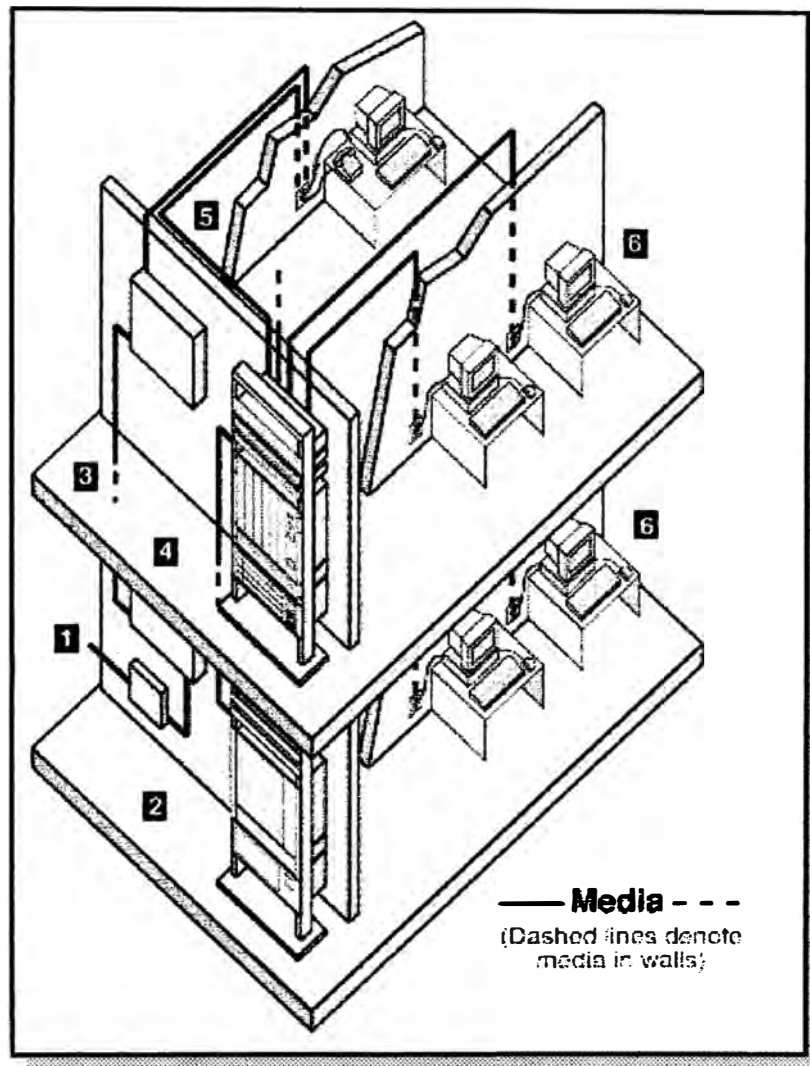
Los 6 subsistemas de un Sistema de Cableado Estructurado
